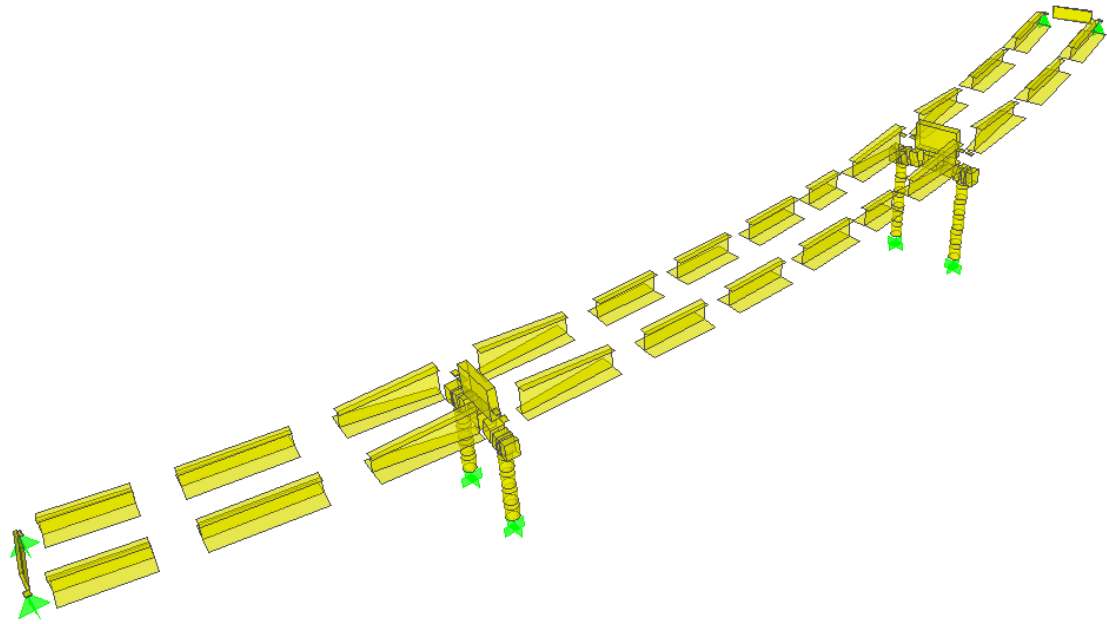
Modelación de las vigas metálicas de sección variable.
